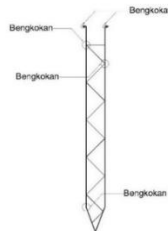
26 Detail Panjang Tulangan Straus Pile Paket 2
